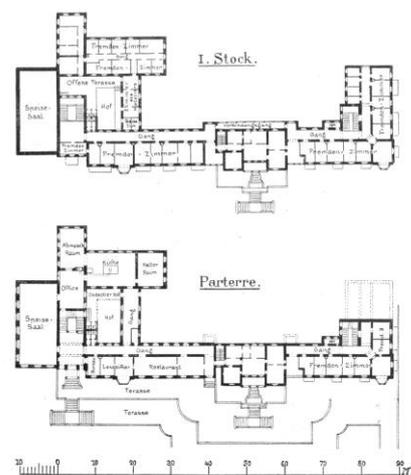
Grand-Hôtel Penegal, Mendelpass, Grundrisse.
